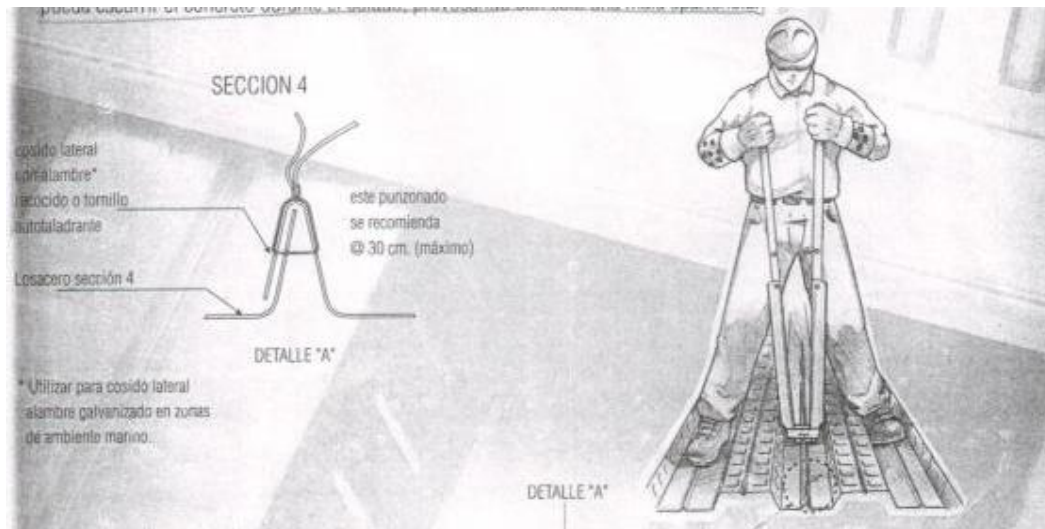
Detalle A. Perforación de la lámina y cosido para traslape en losacero sección 4.
